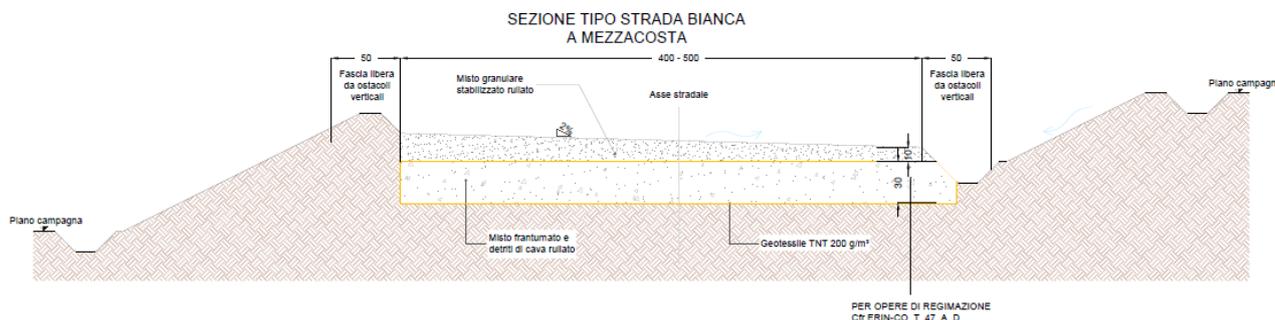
Sezione tipo di strada bianca di impianto - misure in cm
